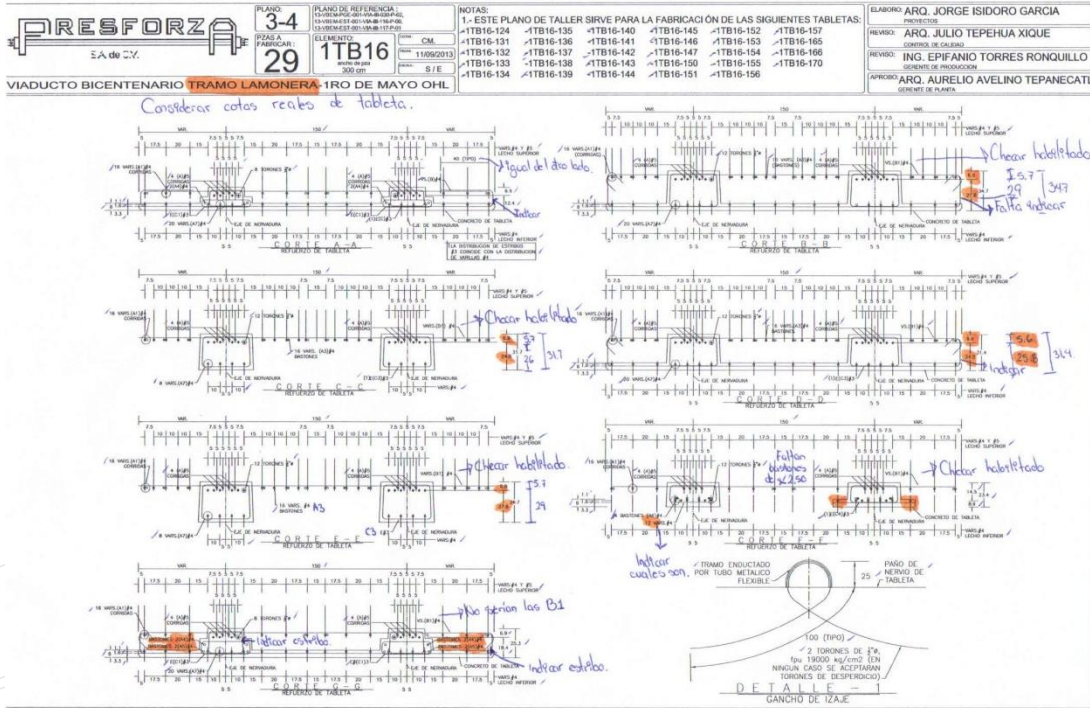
Correcciones indicadas en el plano estructural (detalles constructivos, ganchos de izaje y cortes transversales) de las pelosas.
